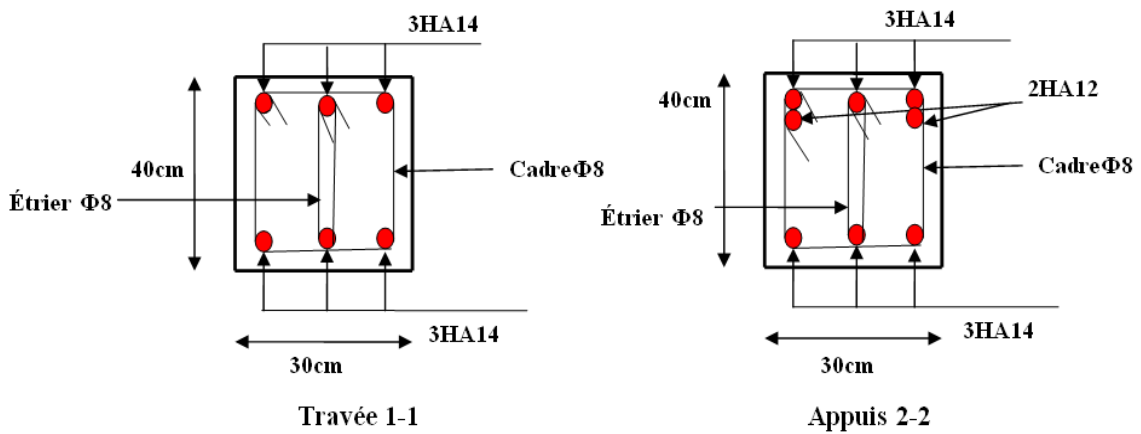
Schéma de ferrailage de la poutre principale de l'étage courant
